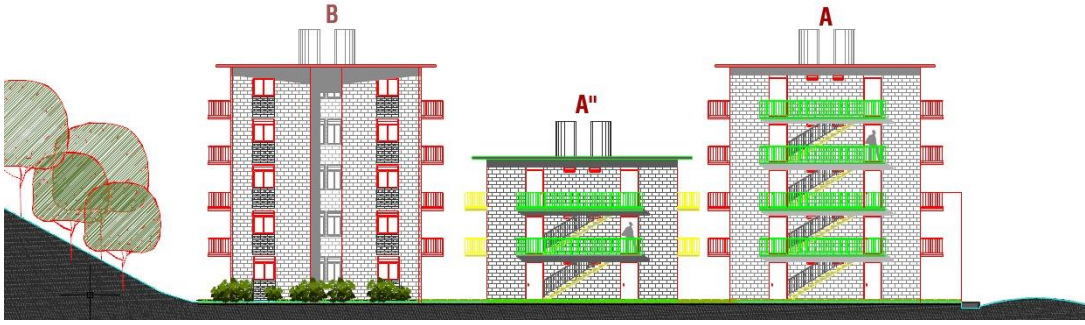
Fachada occidental del proyecto. Fuente: VIVA
